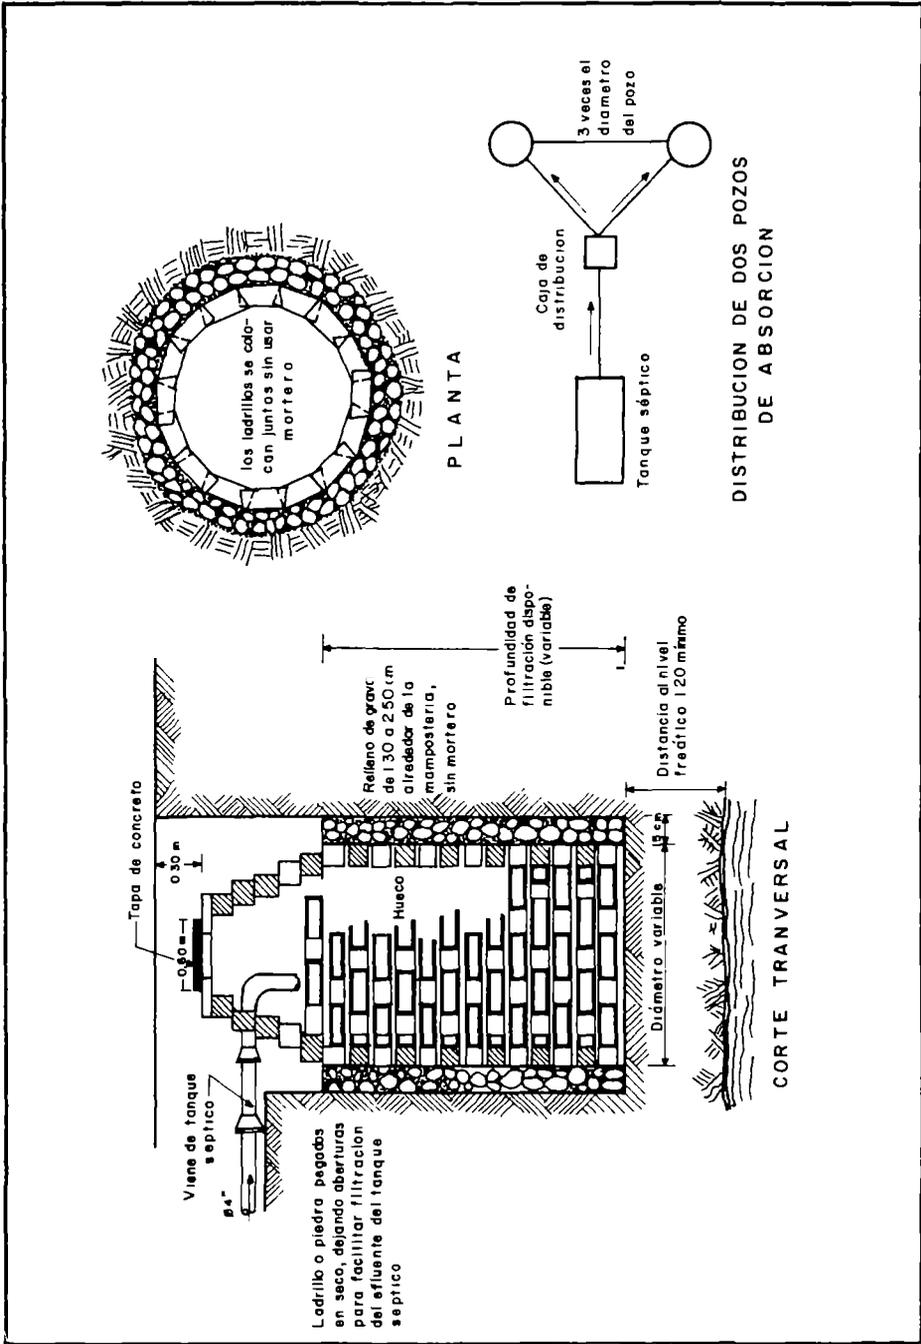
Pozo de absorción, corte transversal y planta.
